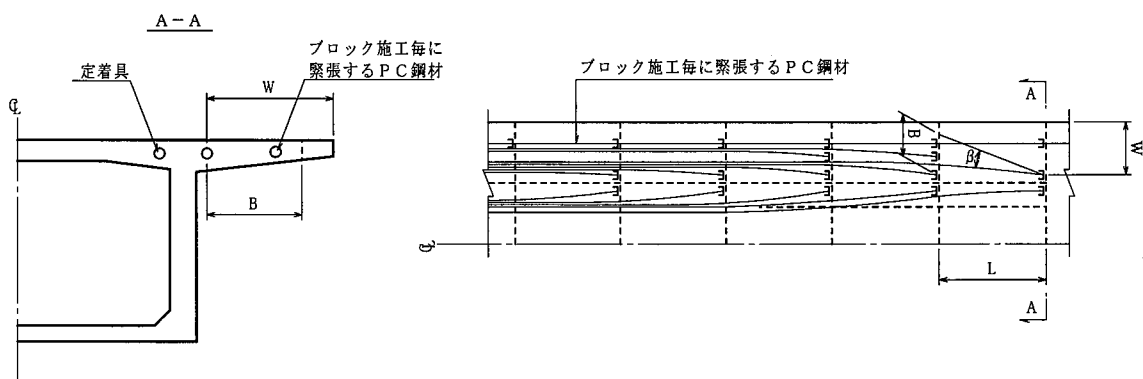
床版先端部PC鋼材配置(PC鋼棒の例)
